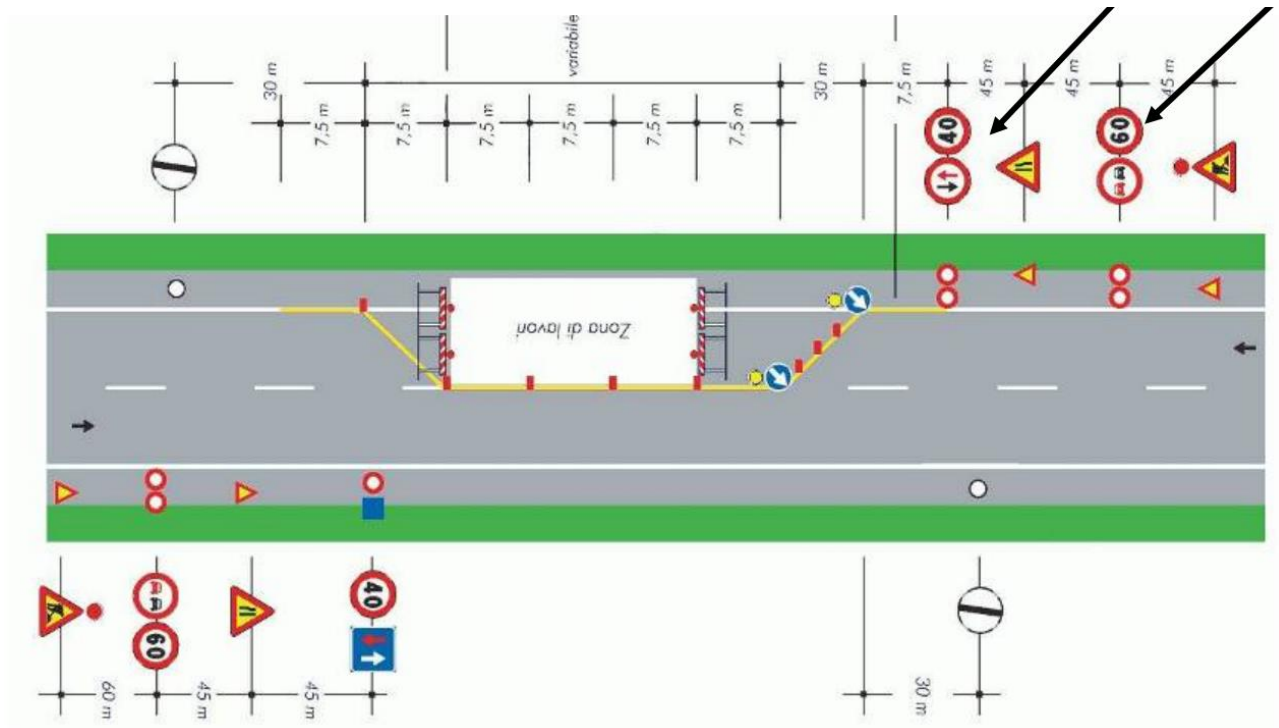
Esempio cantiere stradale con limitazione della velocità con senso unico alternato a vista
